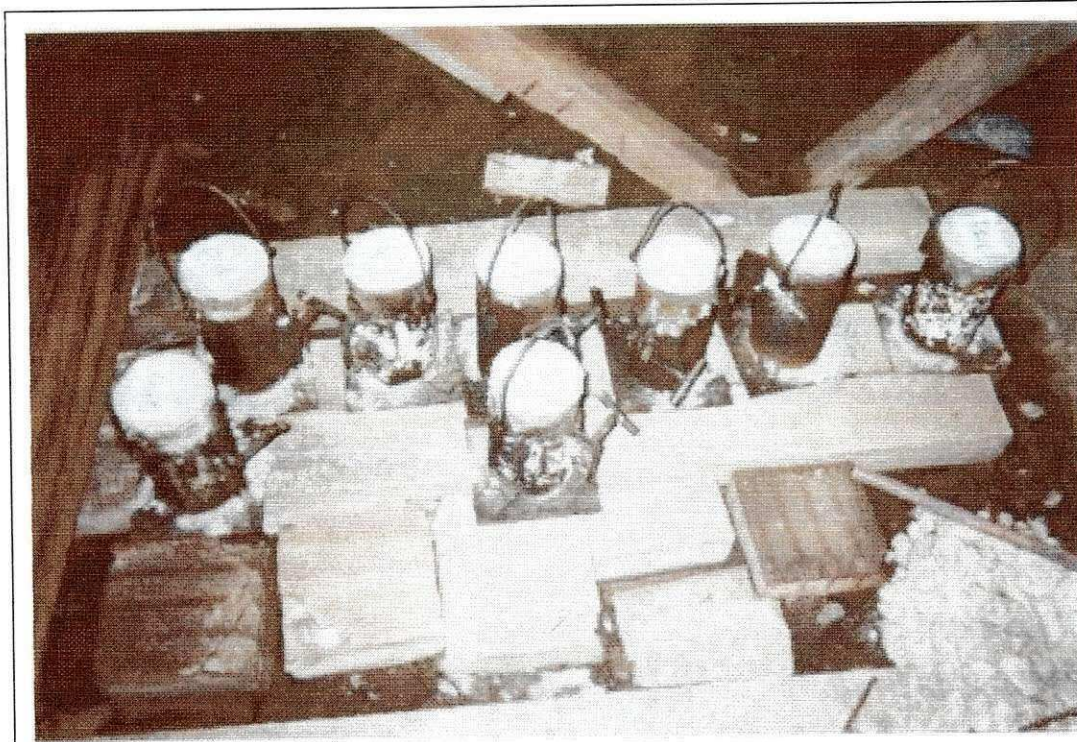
Amostras de concreto retiradas *in loco*, no ato da concretagem. Na superfície, etiquetas identificando a betonada.
